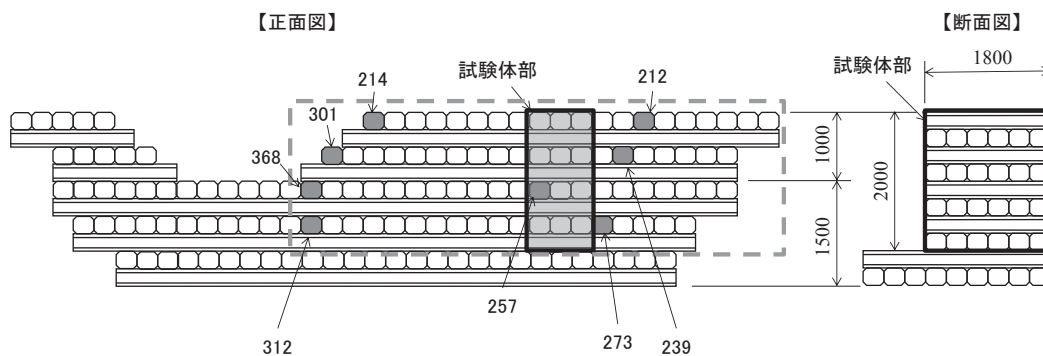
対象とした治山ダムの構造図と部材試験および載荷試験の試験体位置
